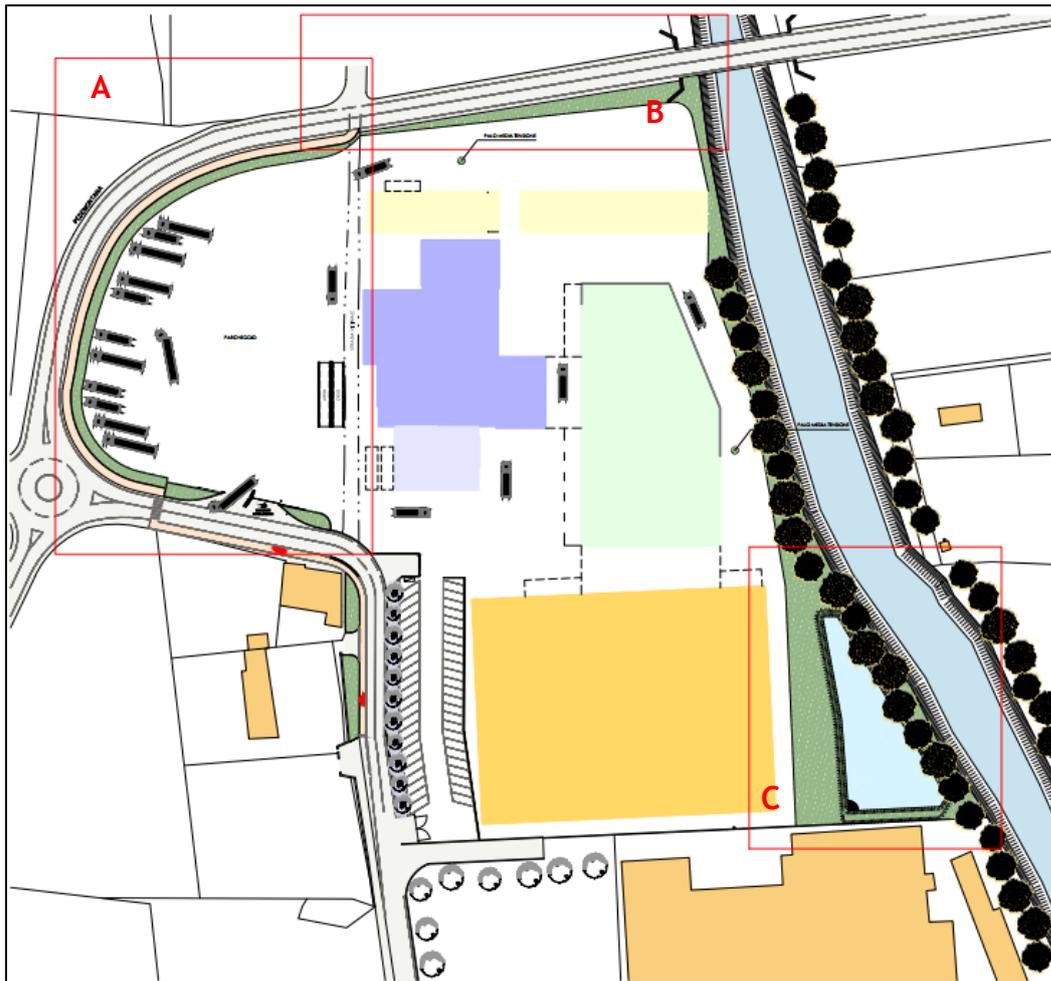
DIVISIONE DELLE AREE A VERDE, OGGETTO DI SINGOLE PROGETTAZIONI
